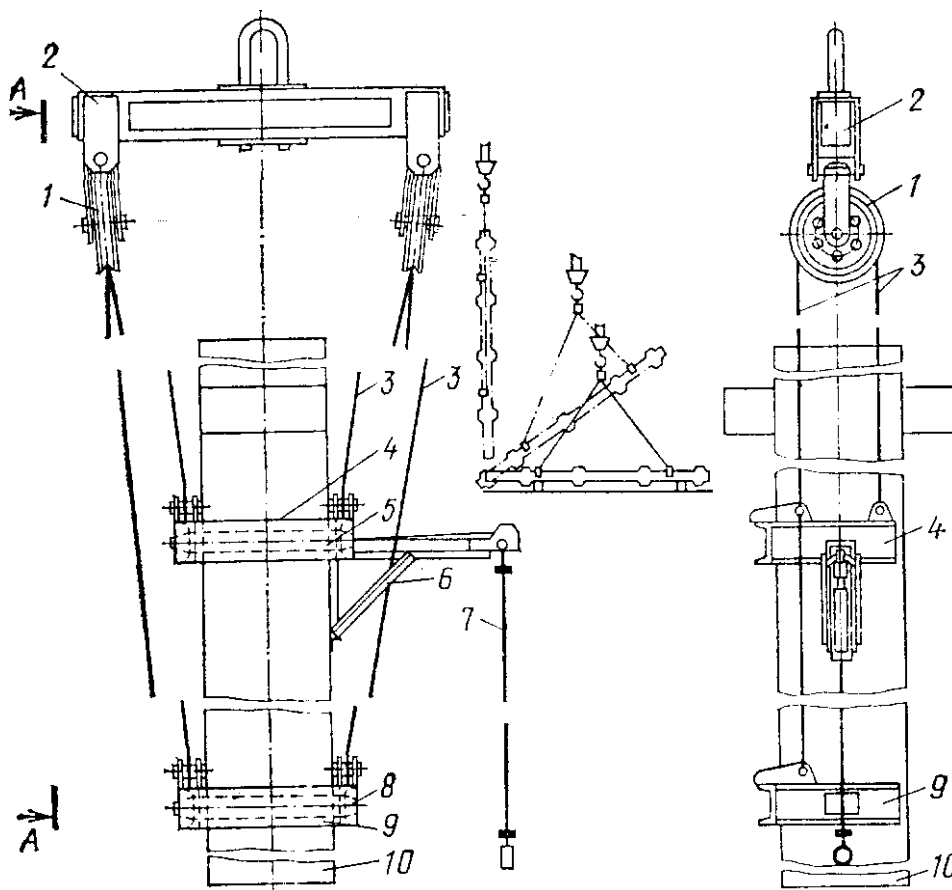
Двоштирьова балансирна захватка: 1 – блок; 2 – траверси; 3 – сталеві канати; 4 – верхня рамка; 5 – верхній штир; 6 – кронштейн; 7 – сталевий канат для витягування штиря; 8 – нижній штир; 9 – нижня рамка; 10 – колона
